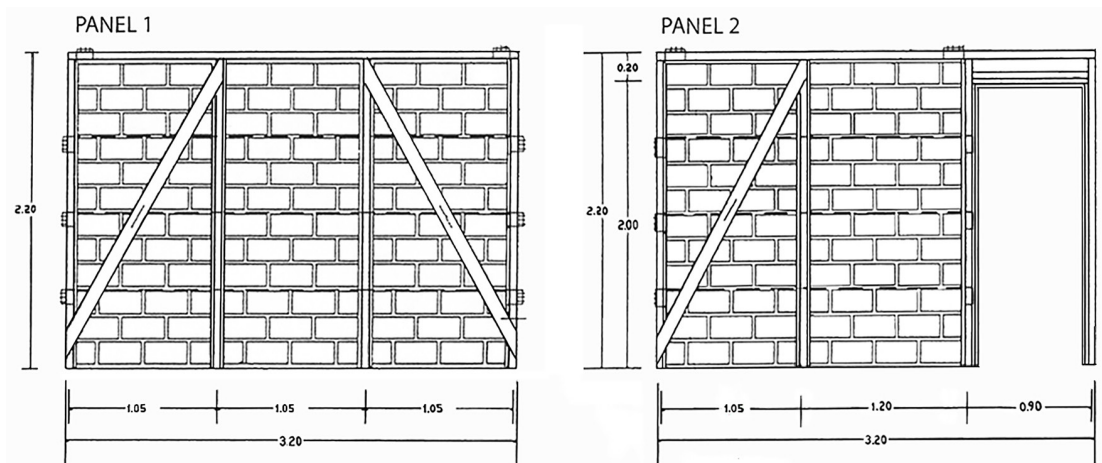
Paneles de muro LAD-MA 1 Y 2.
